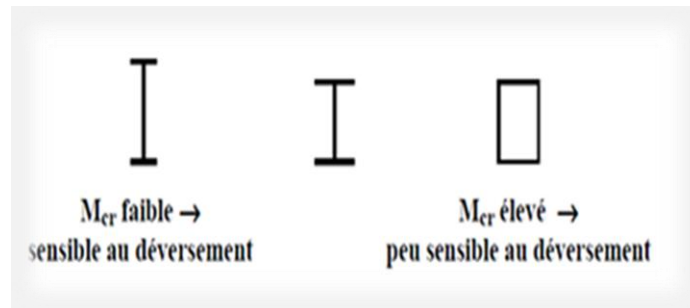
Poutres en I sensible ou déversement et des poutres en caisson Peu sensible. [14]
